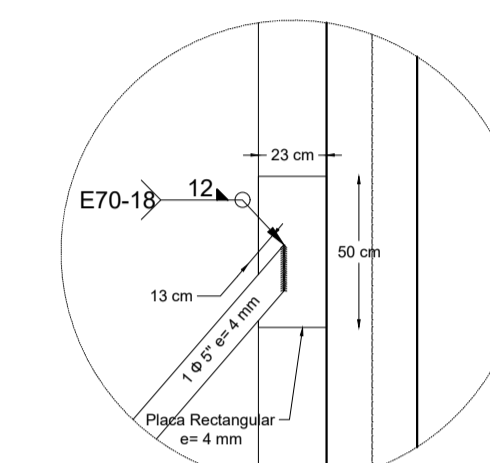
DETAILLE DE CONEXIÓN DE PLACA A TUBERÍA
